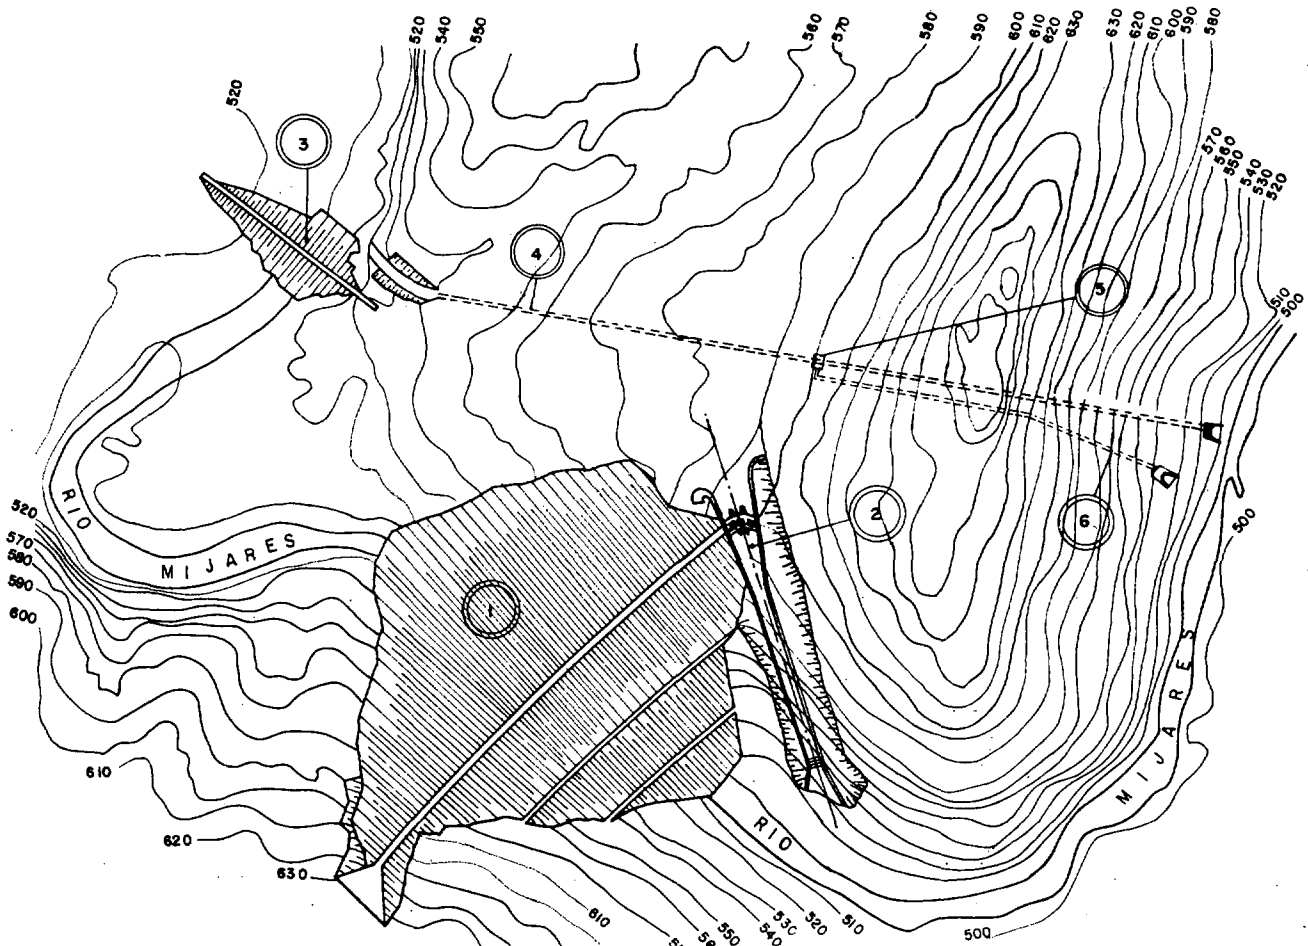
Planta general. 1, presa; 2, aliviadero; 3, ataguía; 4, túnel de desvío y desagües de fondo; 5, cámara de llaves; 6, galería acceso cámara de llaves.
